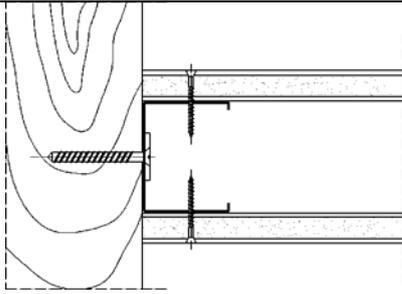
Départ de cloison sur structure bois - Fixation par vissage
